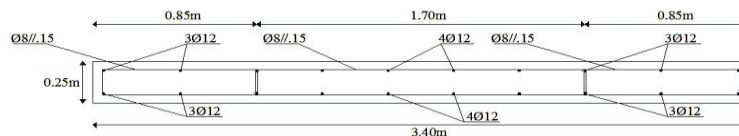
Figura F – Secção transversal das paredes resistentes de betão armado adicionadas na direção longitudinal.
